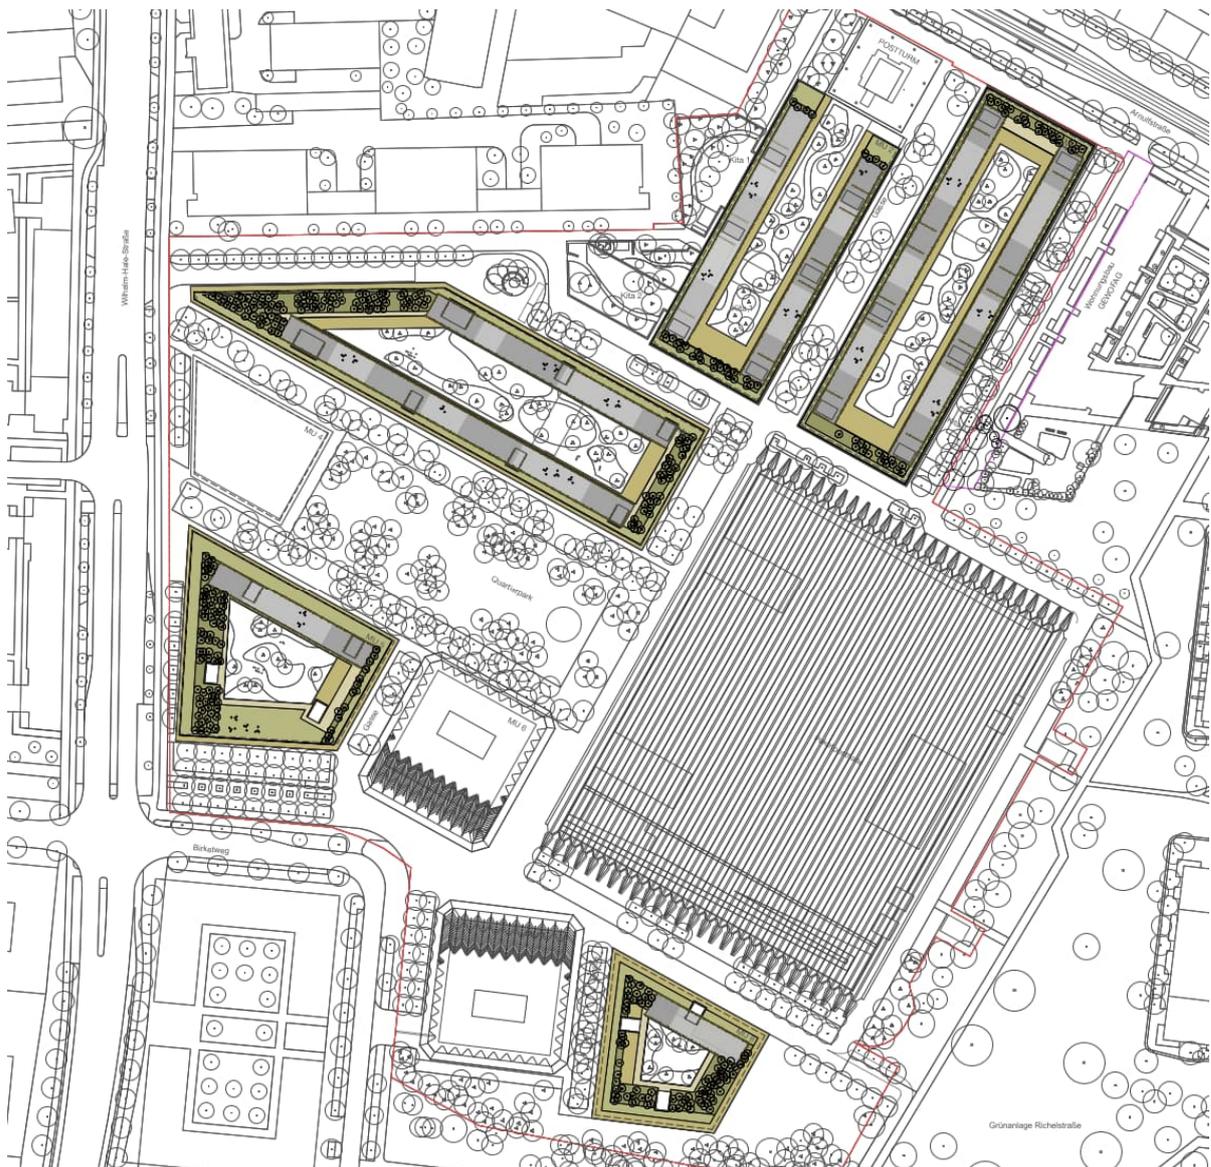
Lageplan Umgebung Dach (Vogt, 2023)
